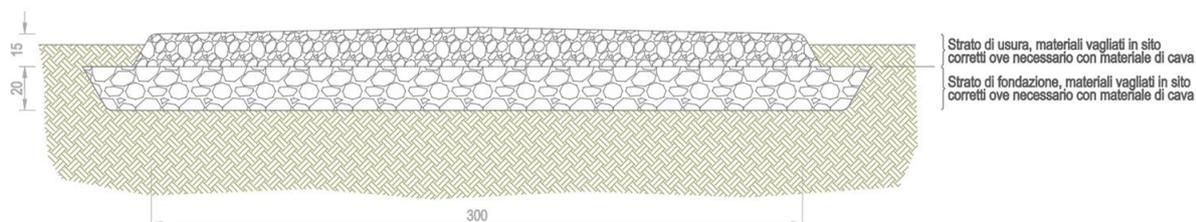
SEZIONE TIPO STRADA BIANCA INTERNA ALL'IMPIANTO
